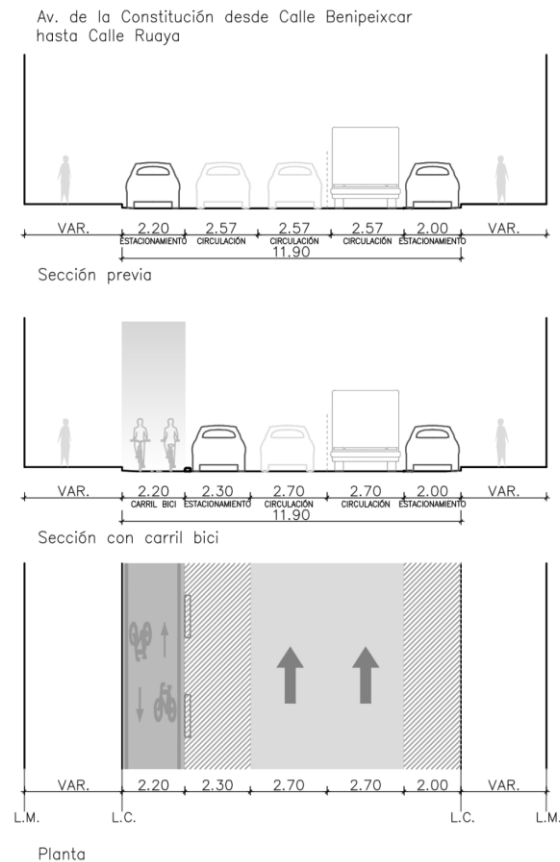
Av. de la Constitución entre C. Benipeixcar y C. Llano de la Zaidía – Sección previa y posterior a la implantación del carril bici
